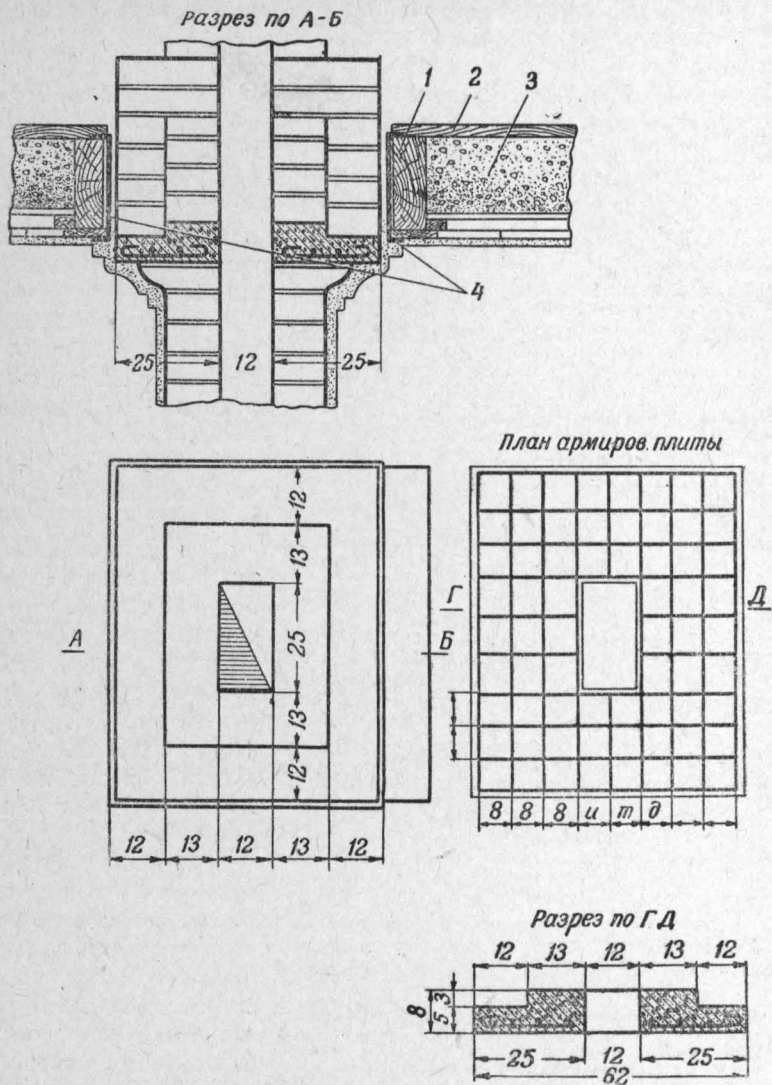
Горизонтальная разделка у дымового канала в чердачном перекрытии для печей с периодической топкой с применением железобетонной ступенчатой плиты:
